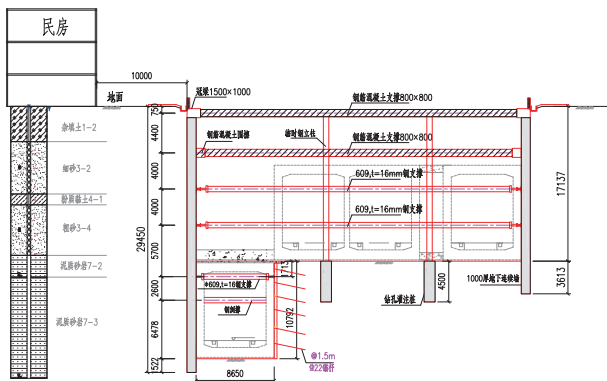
优化后基坑 A-A 剖面图 (单位: mm)
